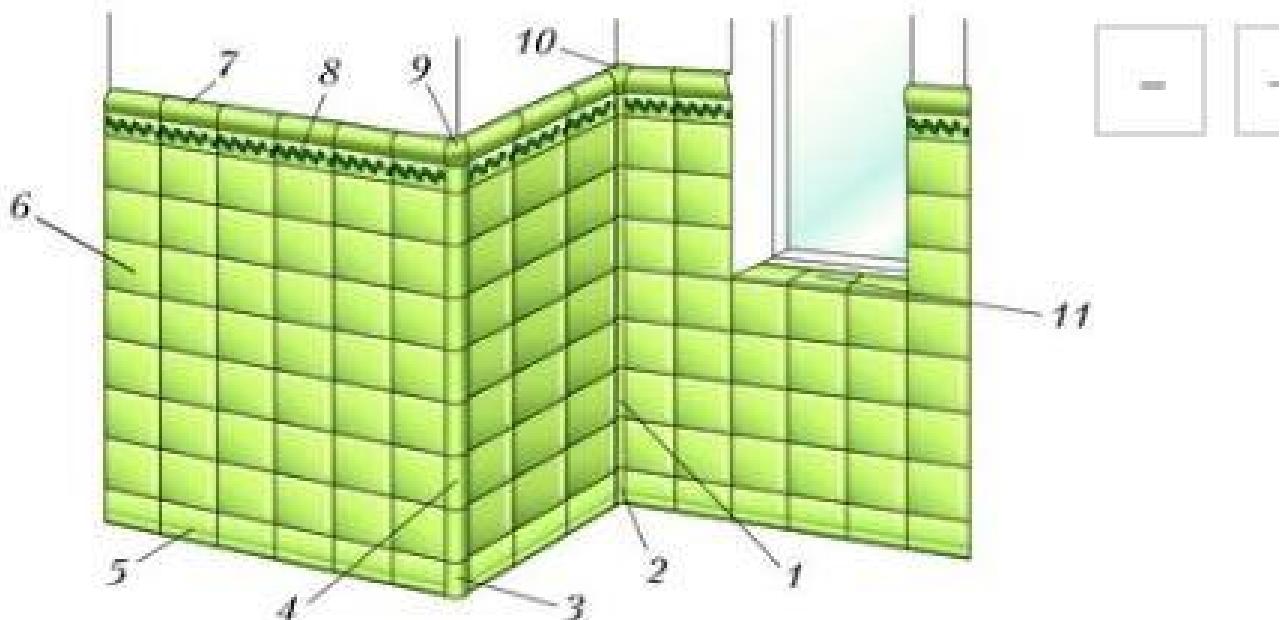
Облицовка стен глазурованной плиткой: 1 – внутренний уголок; 2, 3 – плинтусовые уголки; 4 – внешний уголок; 5 – плинтусовая плитка; 6 – рядовая плитка; 7 – карнизная плитка; 8 – поясок; 9, 10 – уголки карниза; 11 – плитка со скруглённой кромкой (с завалом)
